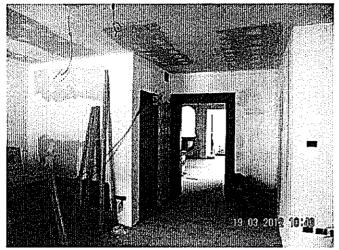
Stanza 6- Vista porta accesso stanza 9 e bagno.
